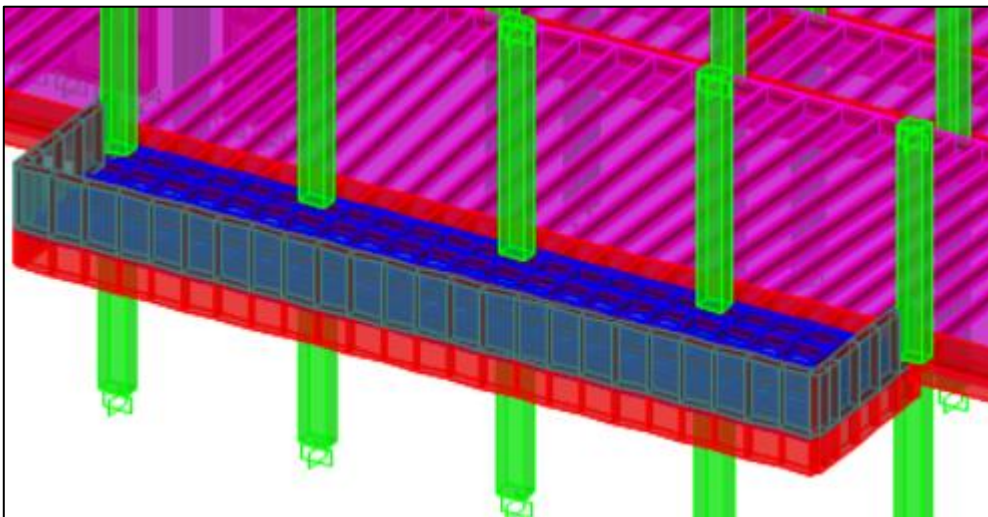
Modellazione soletta piena in calcestruzzo armato a sbalzo del 1° piano
